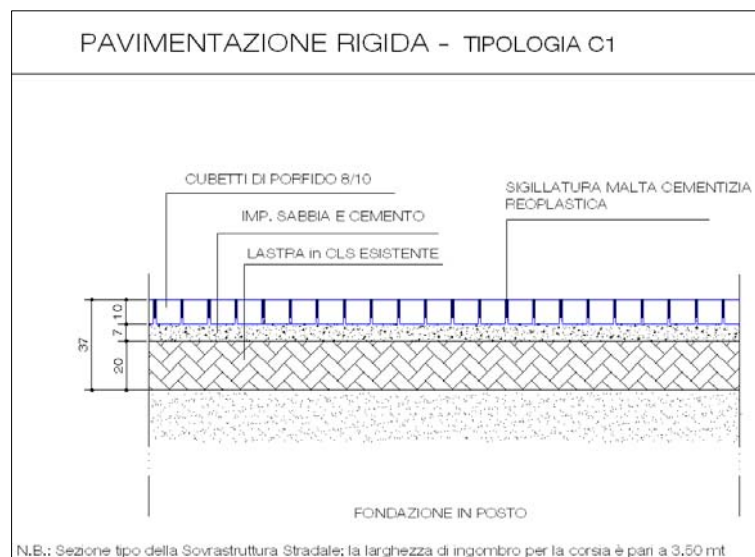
Pacchetto C1 per pavimentazione in pavè con soletta in calcestruzzo
